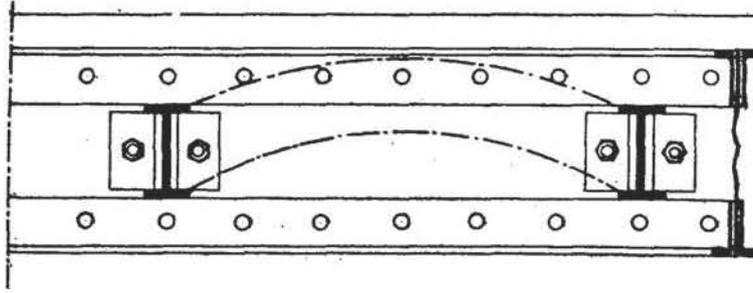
Viguetas ensambladas a la viga maestra: caso de bovedillas con solado de cemento.
